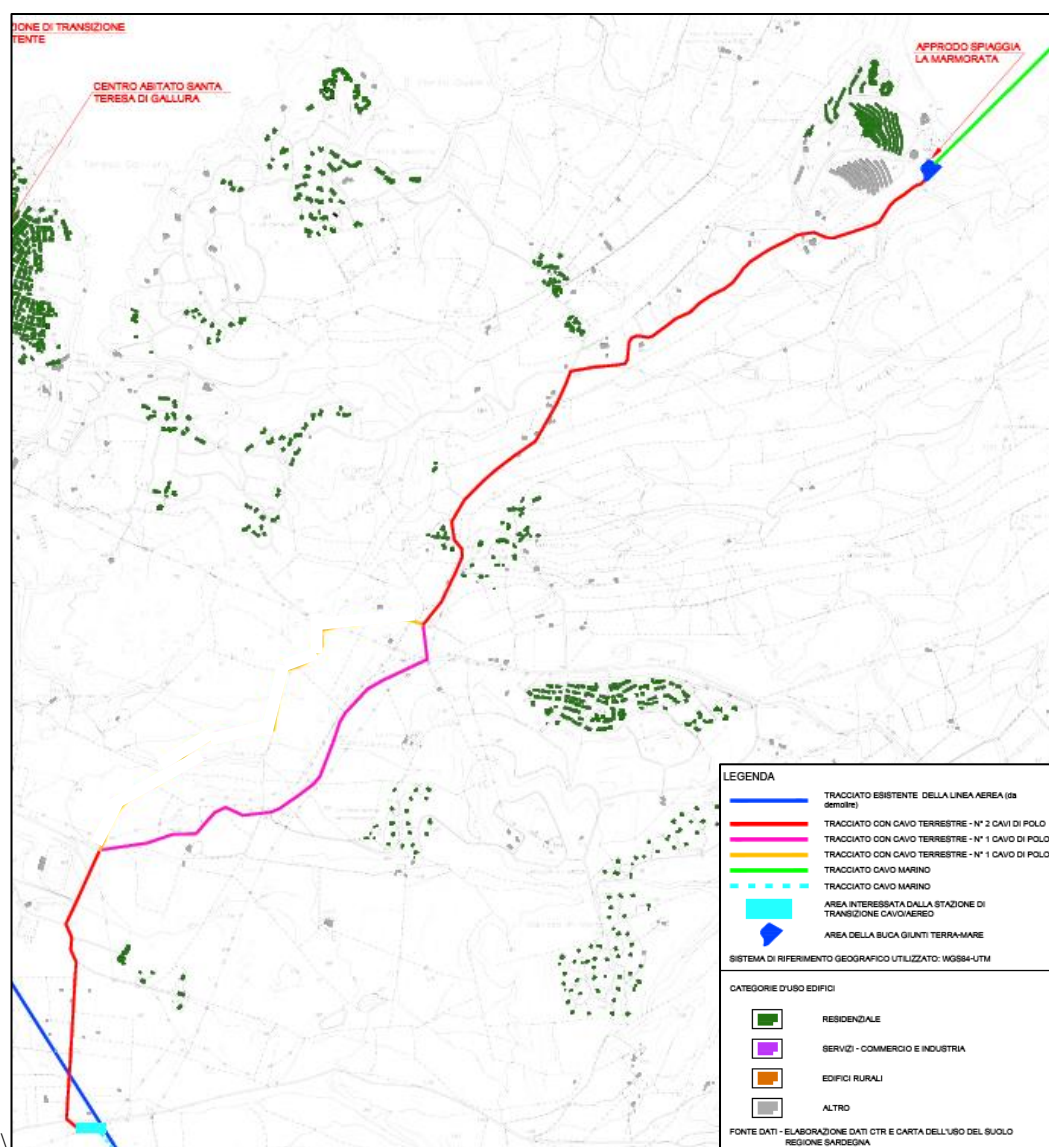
Estratto planimetria DVHR10002BCC00561 – S.S. di Gallura
